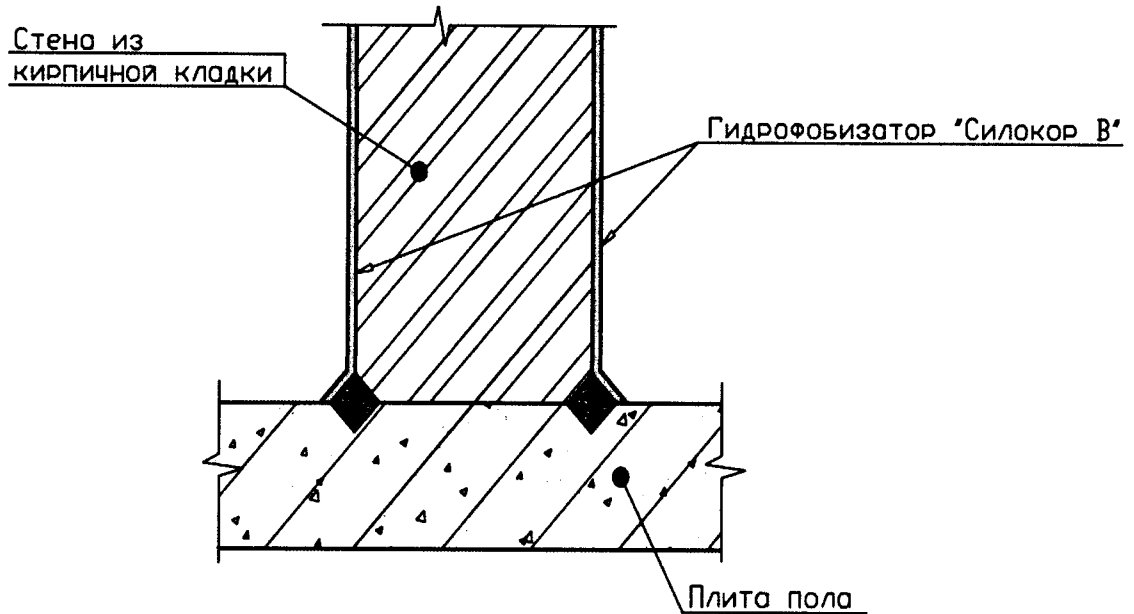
Обработка поверхностей конструкций гидрофобизатором «Силокор». Обработка поверхностей стен из кирпичной кладки
